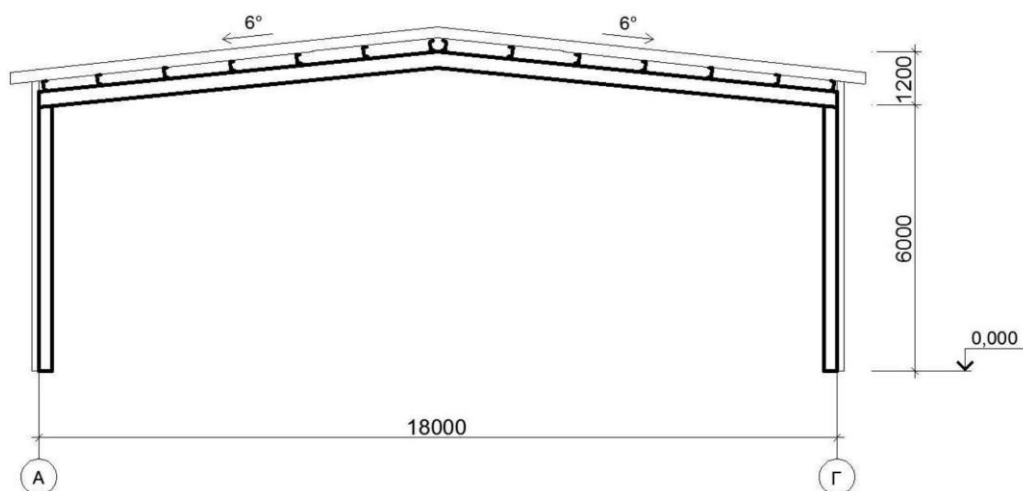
Компонувальна схема поперечної рами будівлі
